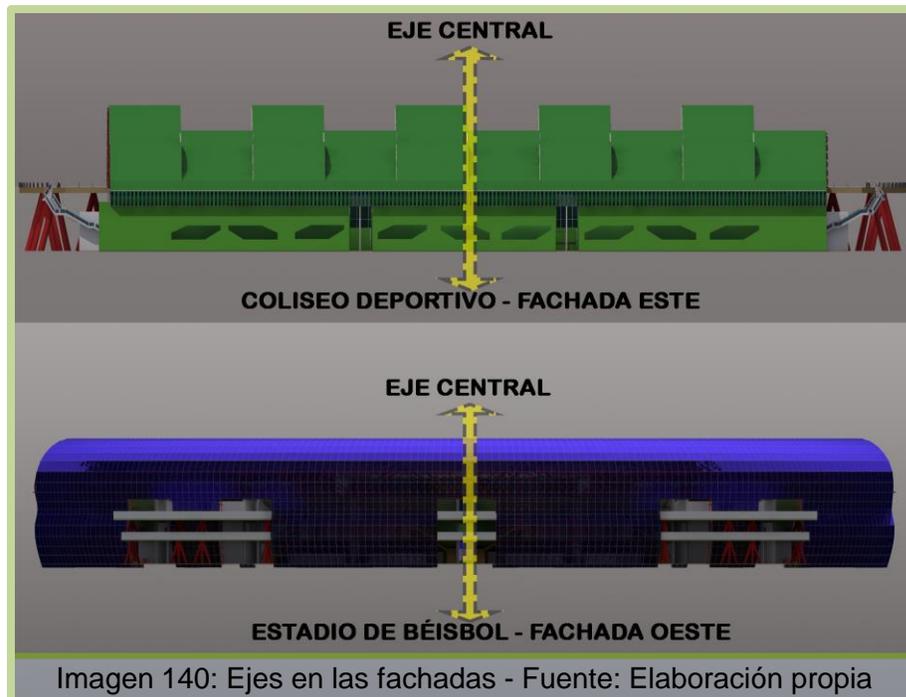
Ejes en las fachadas - Fuente: Elaboración propia
